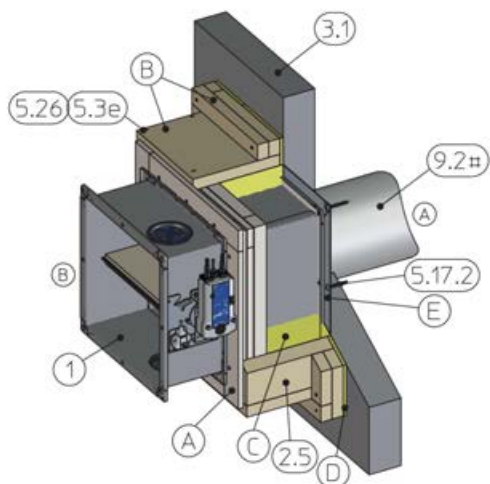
Suchá vestavba na povrch masivní stěny (zobrazena betonová stěna) s instalační sadou WA (nástěnný přídavný díl a omítnuté potrubí)
